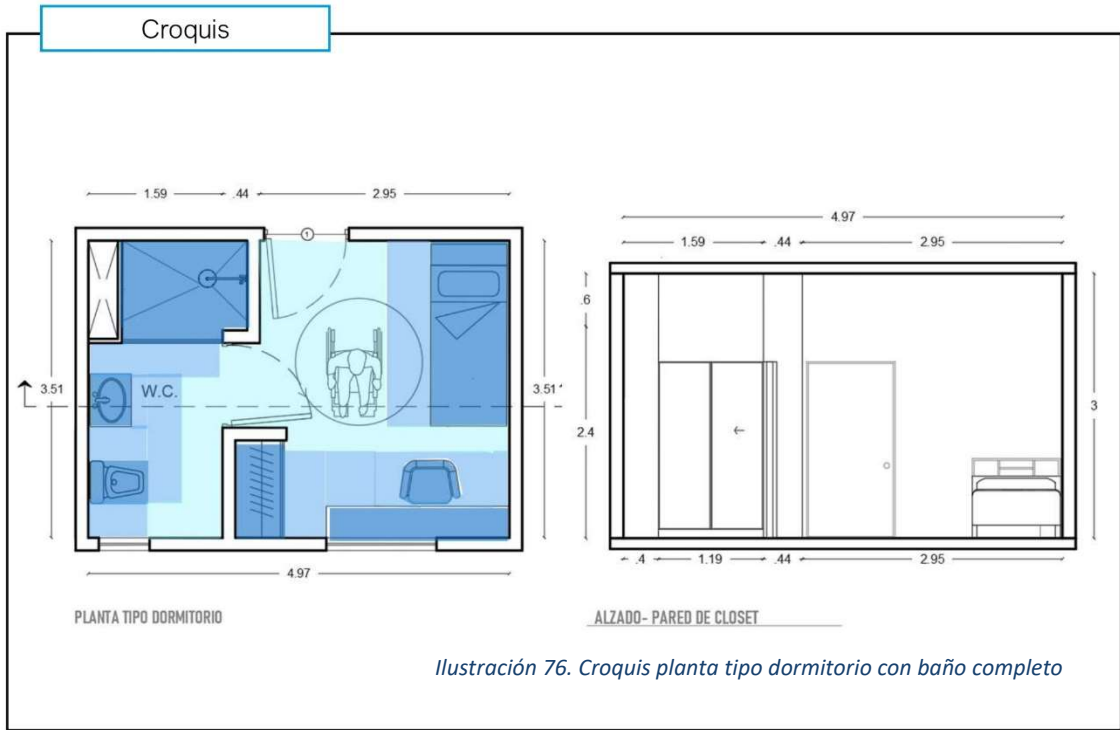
Croquis planta tipo dormitorio con baño completo
